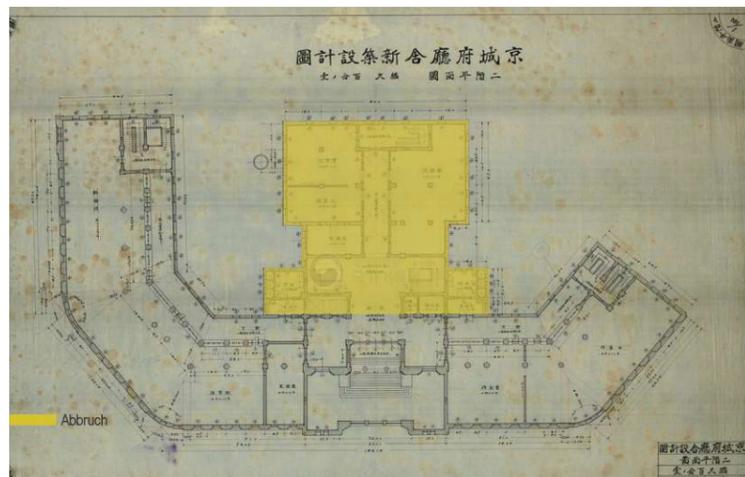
| Erdgeschoss Grundriss des ehemaligen Rathaus von Seoul, 1922-1926, Gelb : Abbruch Bereich, 2008
